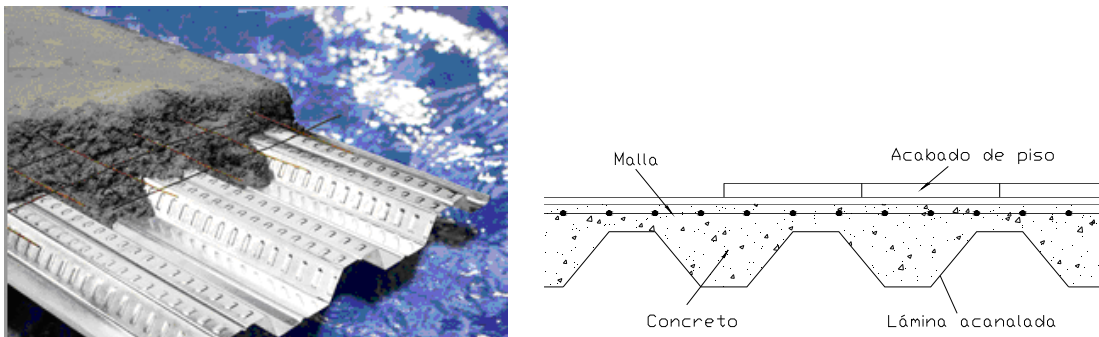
Losa-acero (Láminas y Acanalados Monterrey, 2011)
